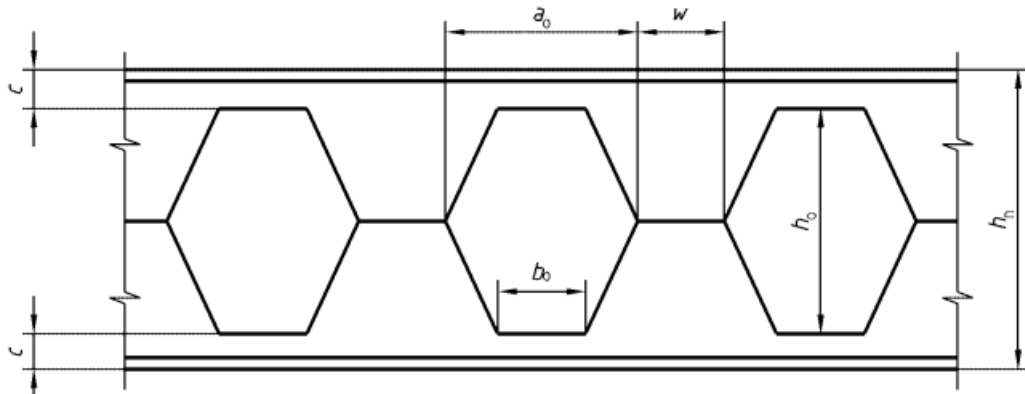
Múltiplas aberturas poligonais na alma [25]
